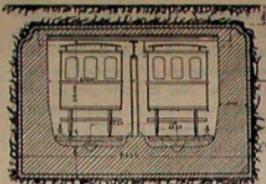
Ferrovia elevata e sotterranea di Berlino. Sezione trasversale del tunnel.
